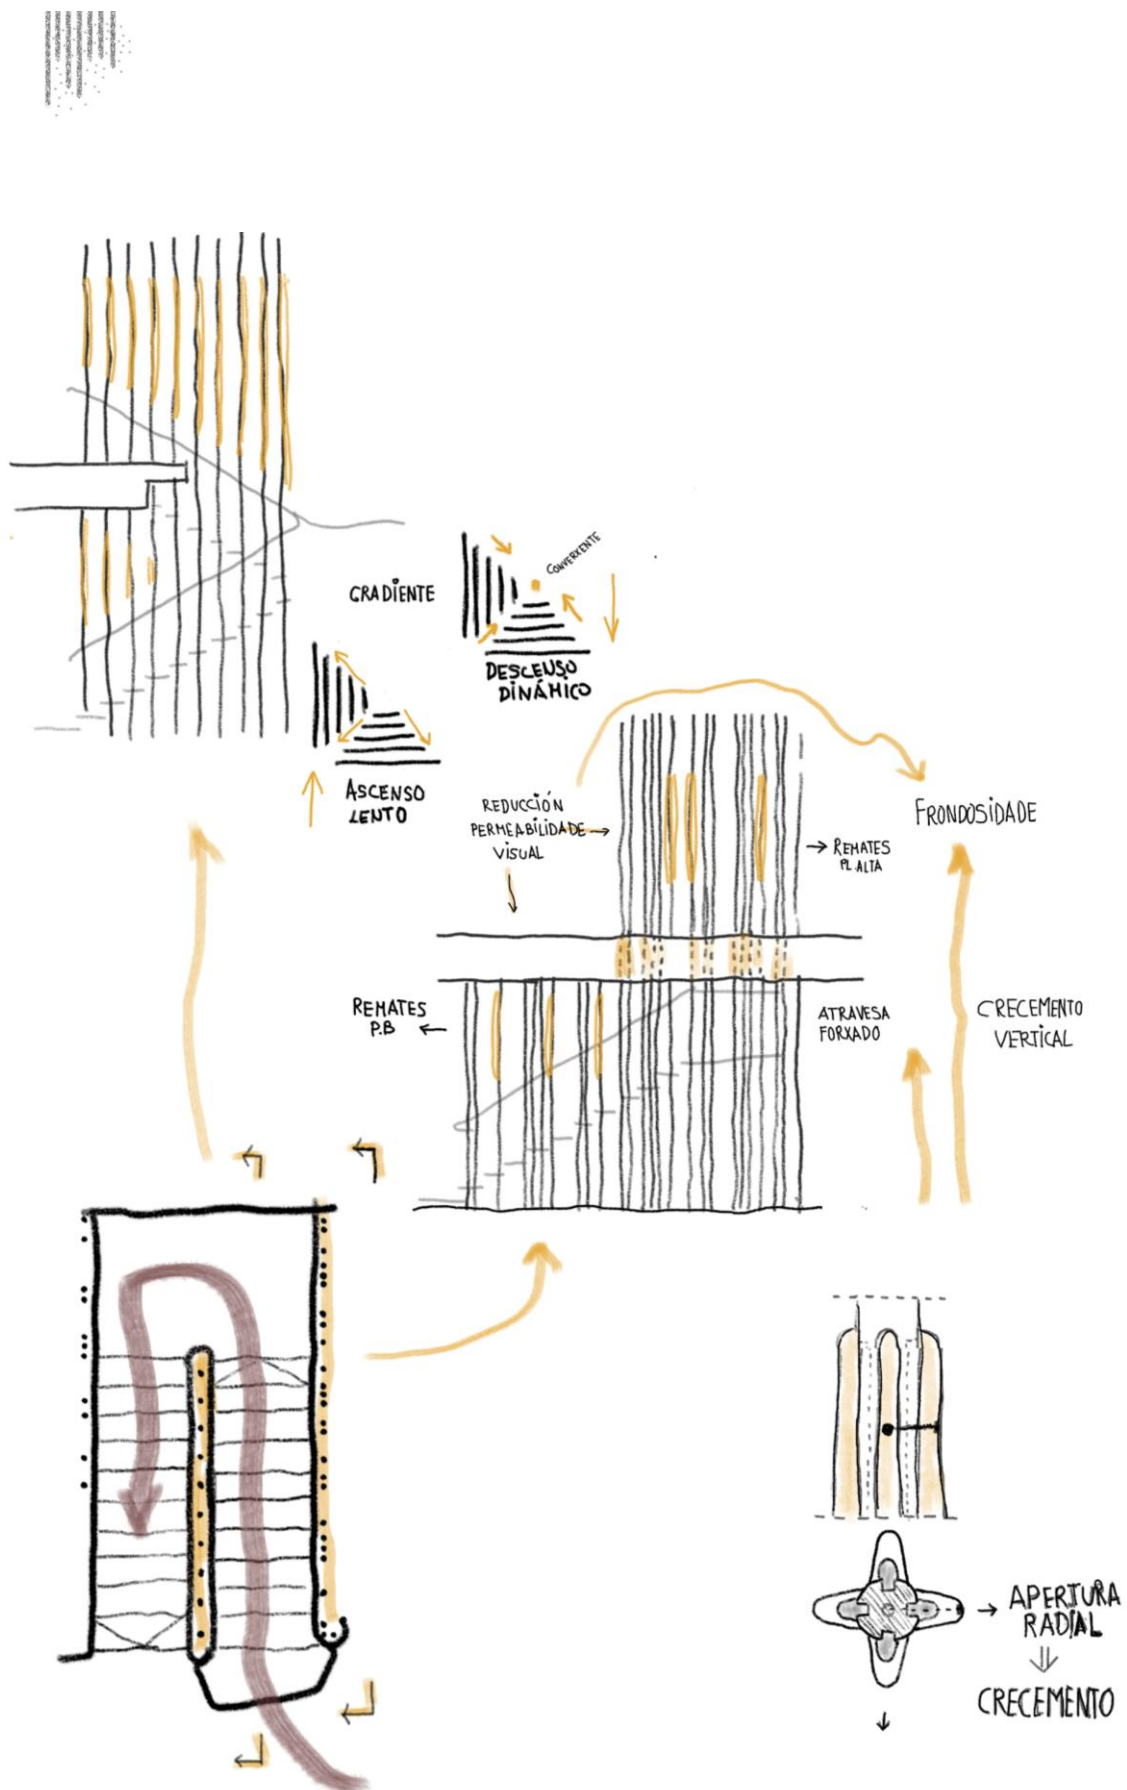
Esquemas de planta, alzado e detalle construtivo soportes escaleira _Elaboración propia
